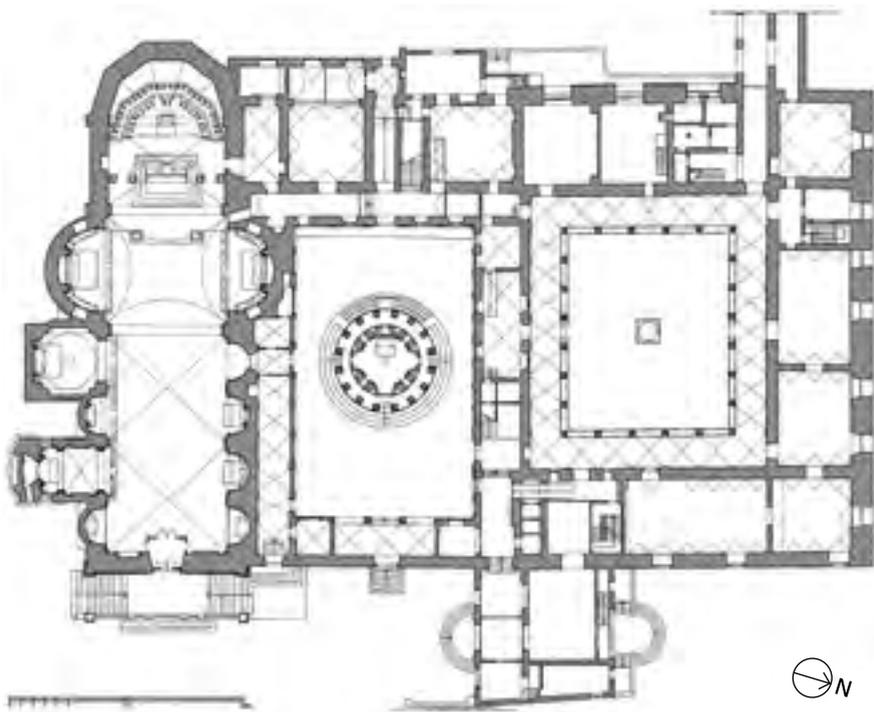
Planimetría del antiguo conjunto conventual de San Pietro in Montorio.
